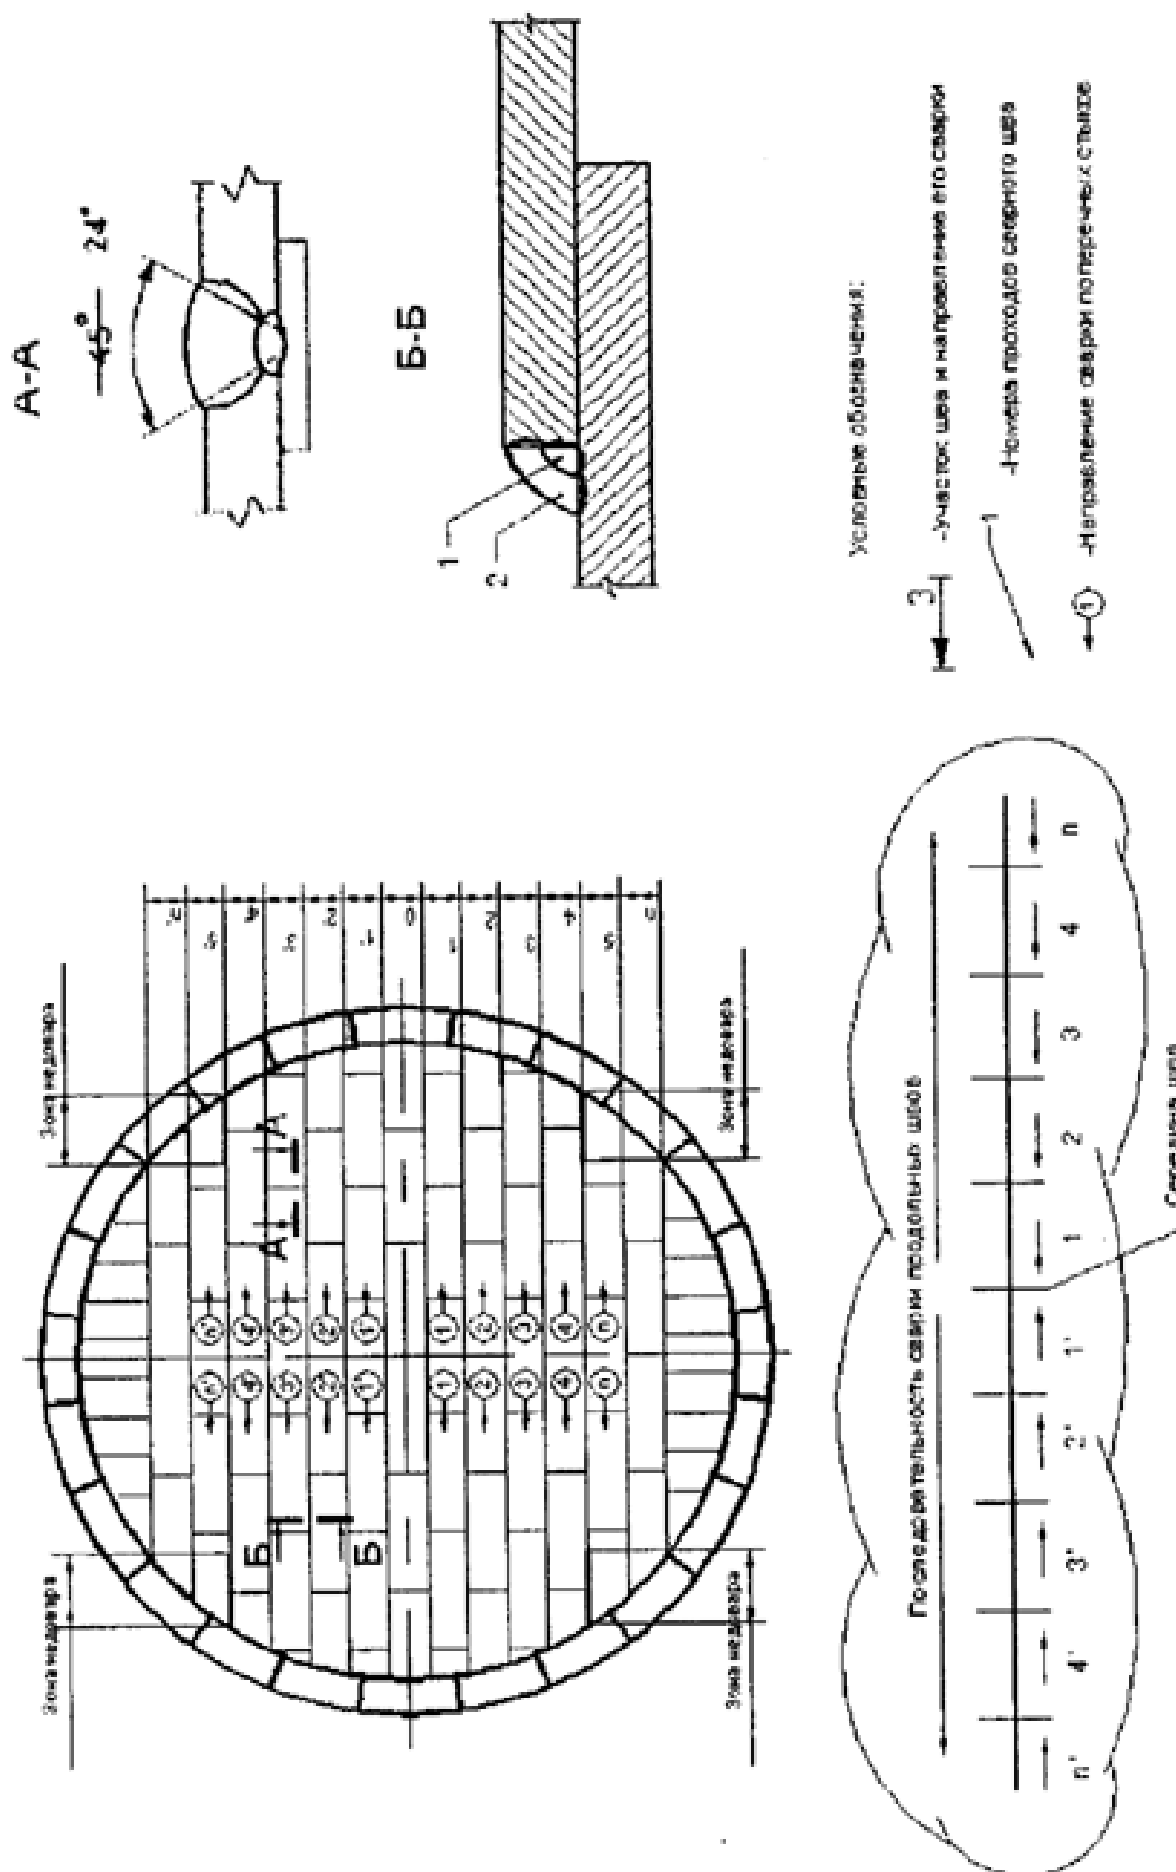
Схема сварки центральной части дна
